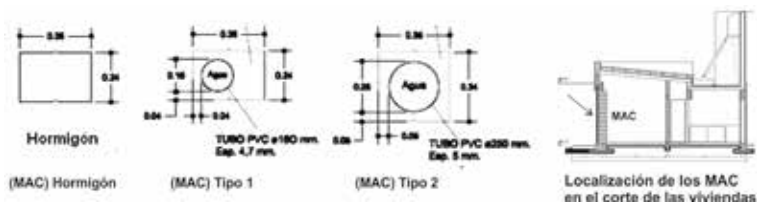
Corte de las piezas que constituyen los tres tipos de MAC y localización en la fachada norte de la vivienda.
